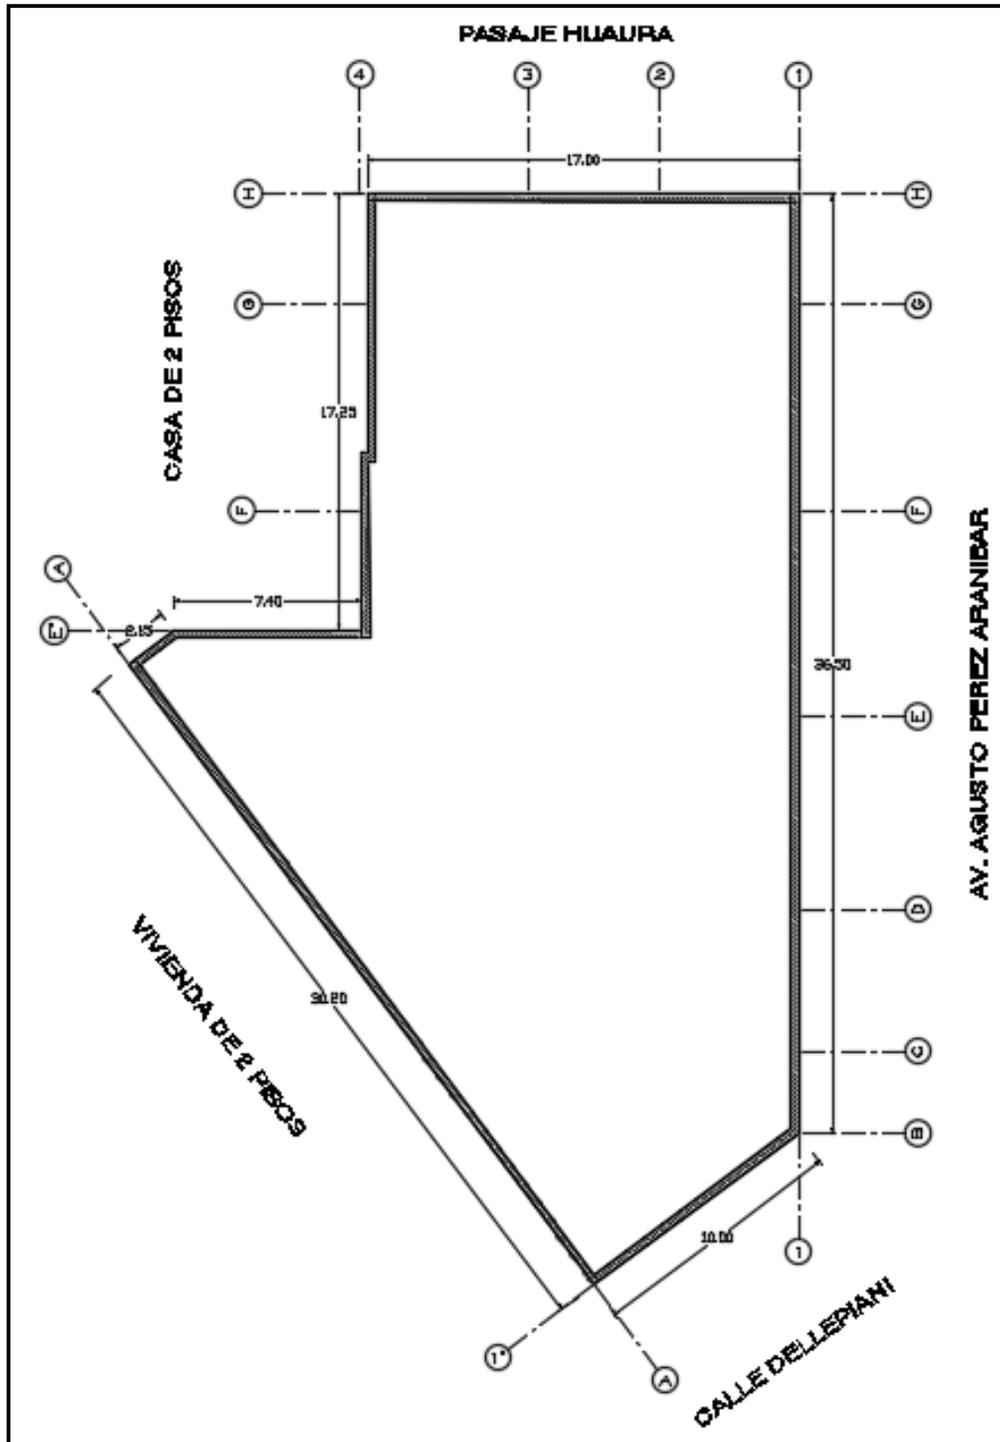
Plano en planta obra 2 – Edificio Crossland.
